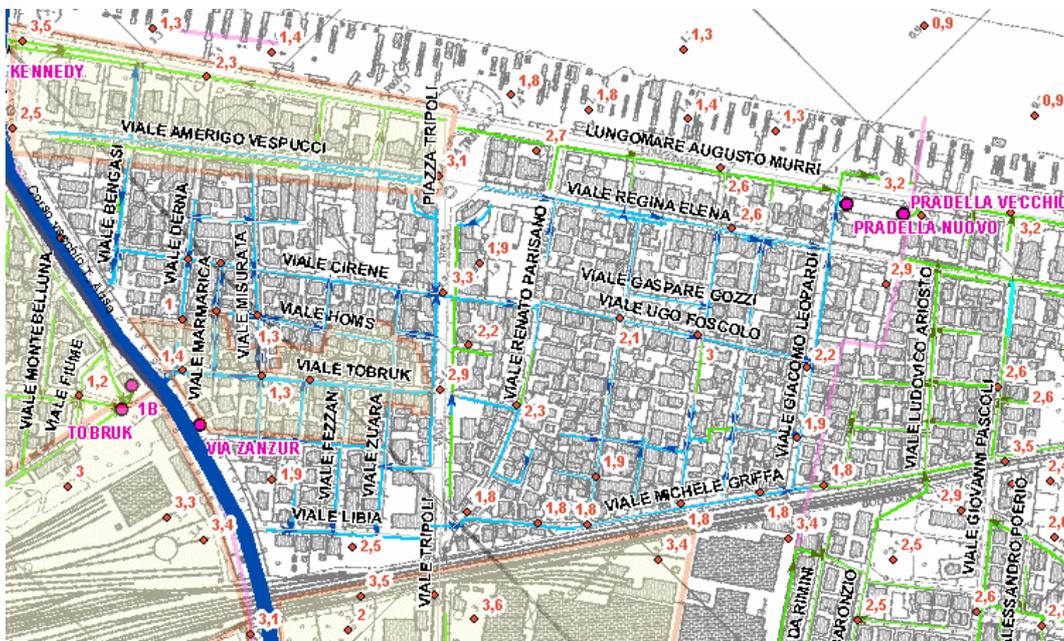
Zona sollevamento di Via Zanzur ed ex fossa Pradella.
